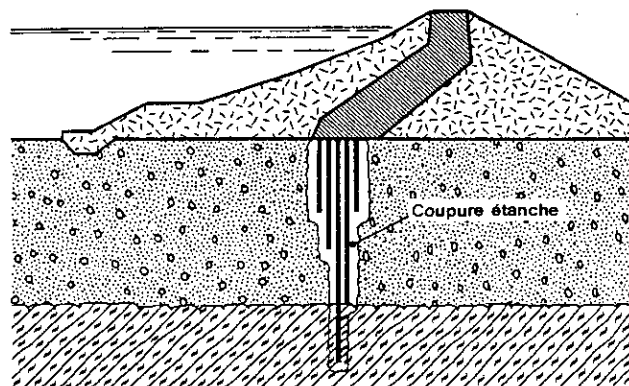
Barrage en terre, coupure étanche verticale (doc. Solétanche)
